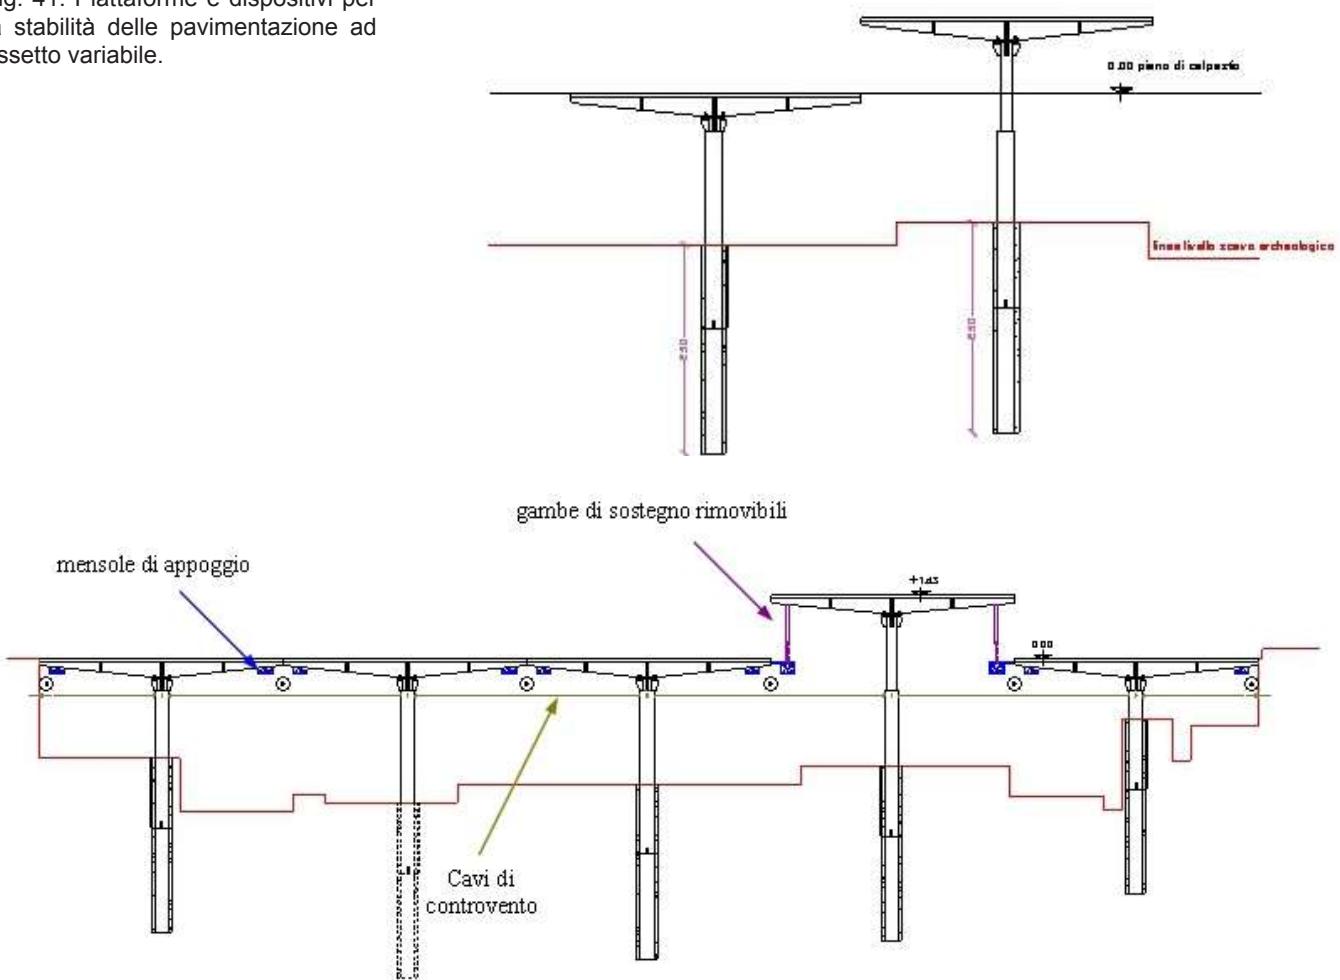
Piattaforme e dispositivi per la stabilità delle pavimentazioni ad assetto variabile.
